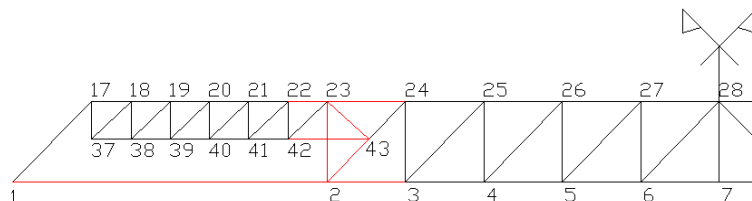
Ilustração do modelo estudado, as barras destacadas são as mais relevantes- Viga 1 Secção 0.5×0.3
